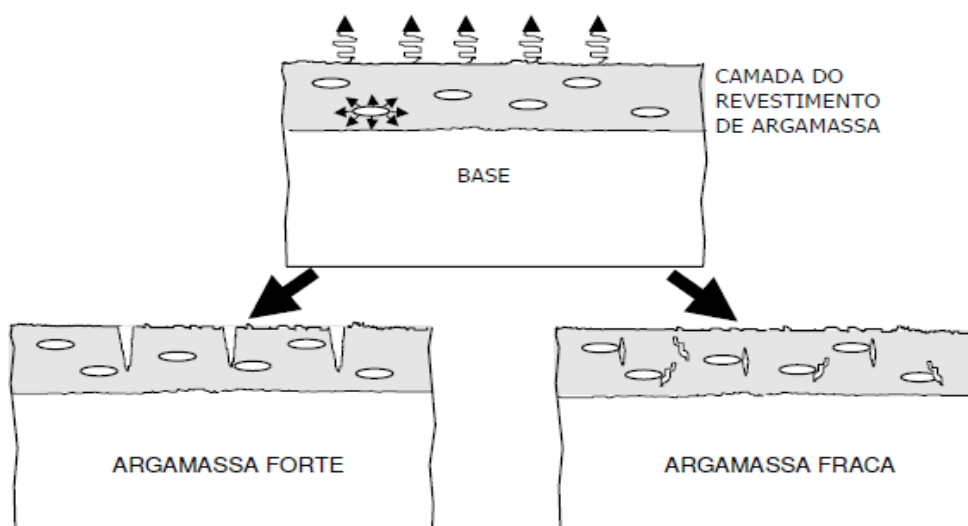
Fissuração da argamassa por retração na secagem
